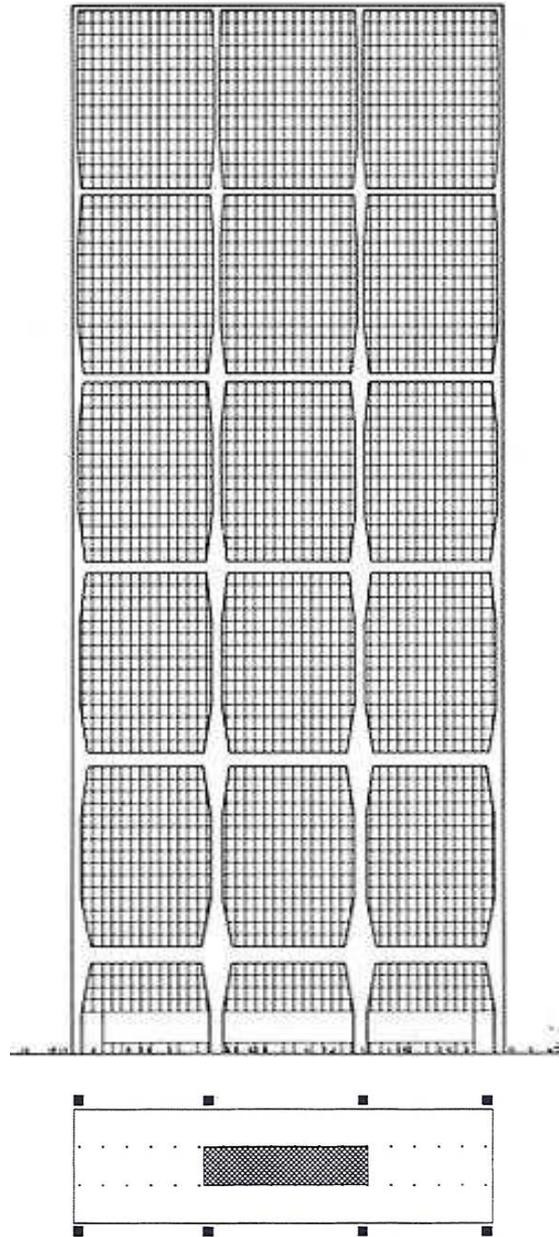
Superestructura de hormigón de Goldsmith para edificio en altura. (Imagen tomada de [Cobrerros Vime 2002, 35]).
